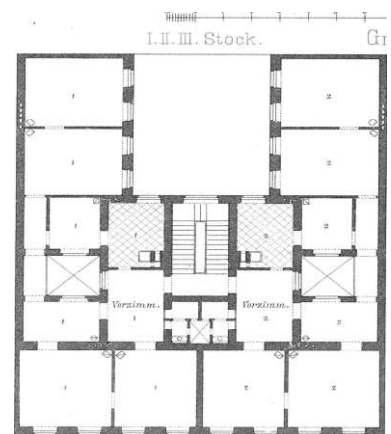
Grundriss 1., 2. und 3. Obergeschoss, Werderthorgasse 9 - Julius Dörfel, 1870
